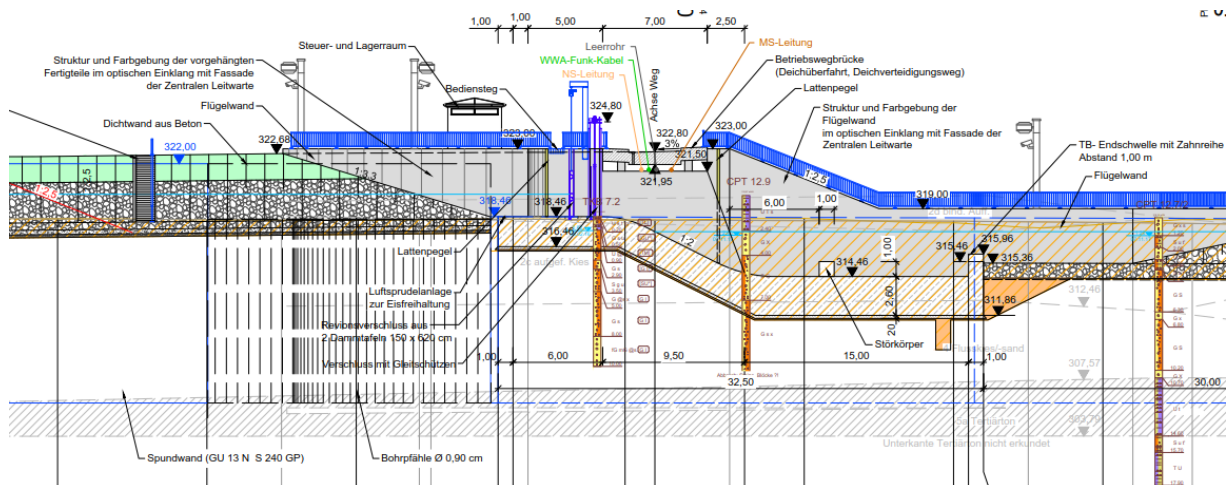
Einlaufbauwerk, Ausschnitt Schnitt A-A (aus Plan 04-01-03, Blatt 1/2)
